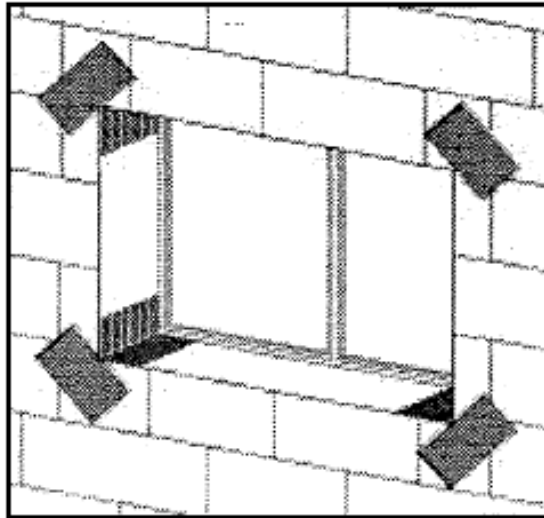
Усиление СФТК в зоне оконных проемов дополнительными элементами из фасадной стеклосетки
